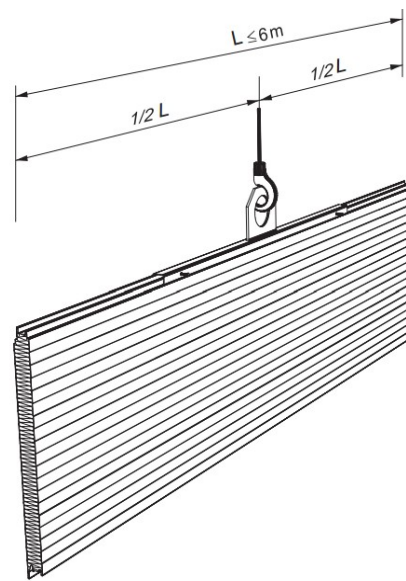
Использование швеллерной накладки для перемещения стеновых панелей ≤ 6 м в длину.
